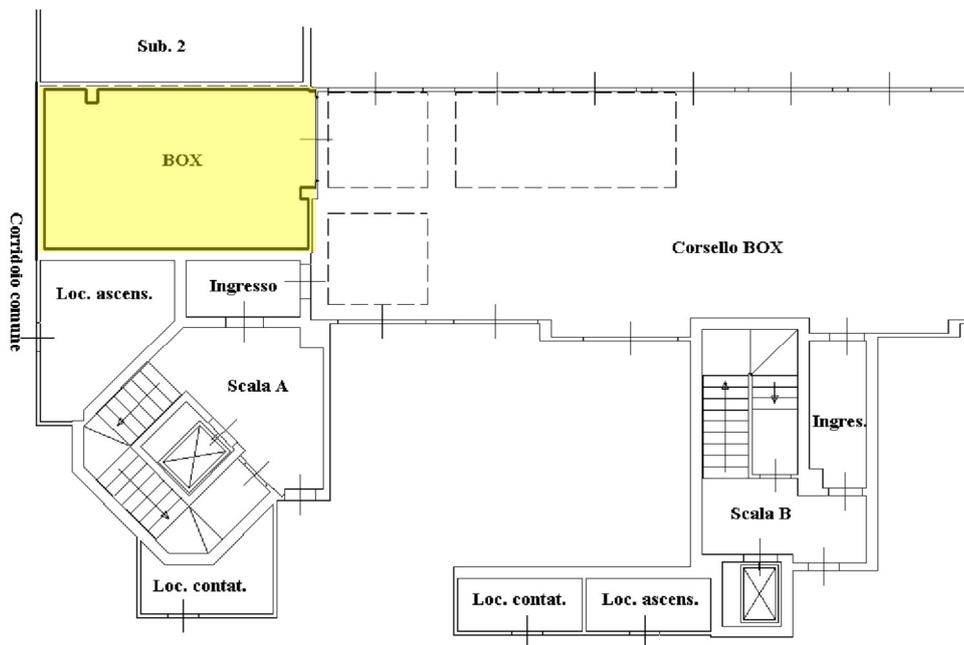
B – Planimetria del Box Auto (evidenziati in giallo) sito in Via Rogerio da Sedriano 21 - Sedriano (MI).
